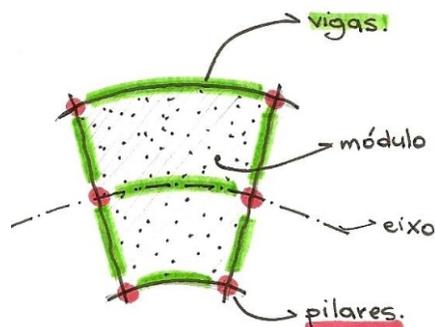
Princípio estrutural, croqui Núcleo Tecnológico
